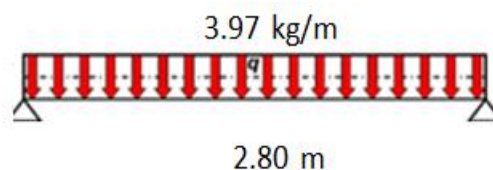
Carga distribuida en la viga segundo piso eje A entre 1-2
